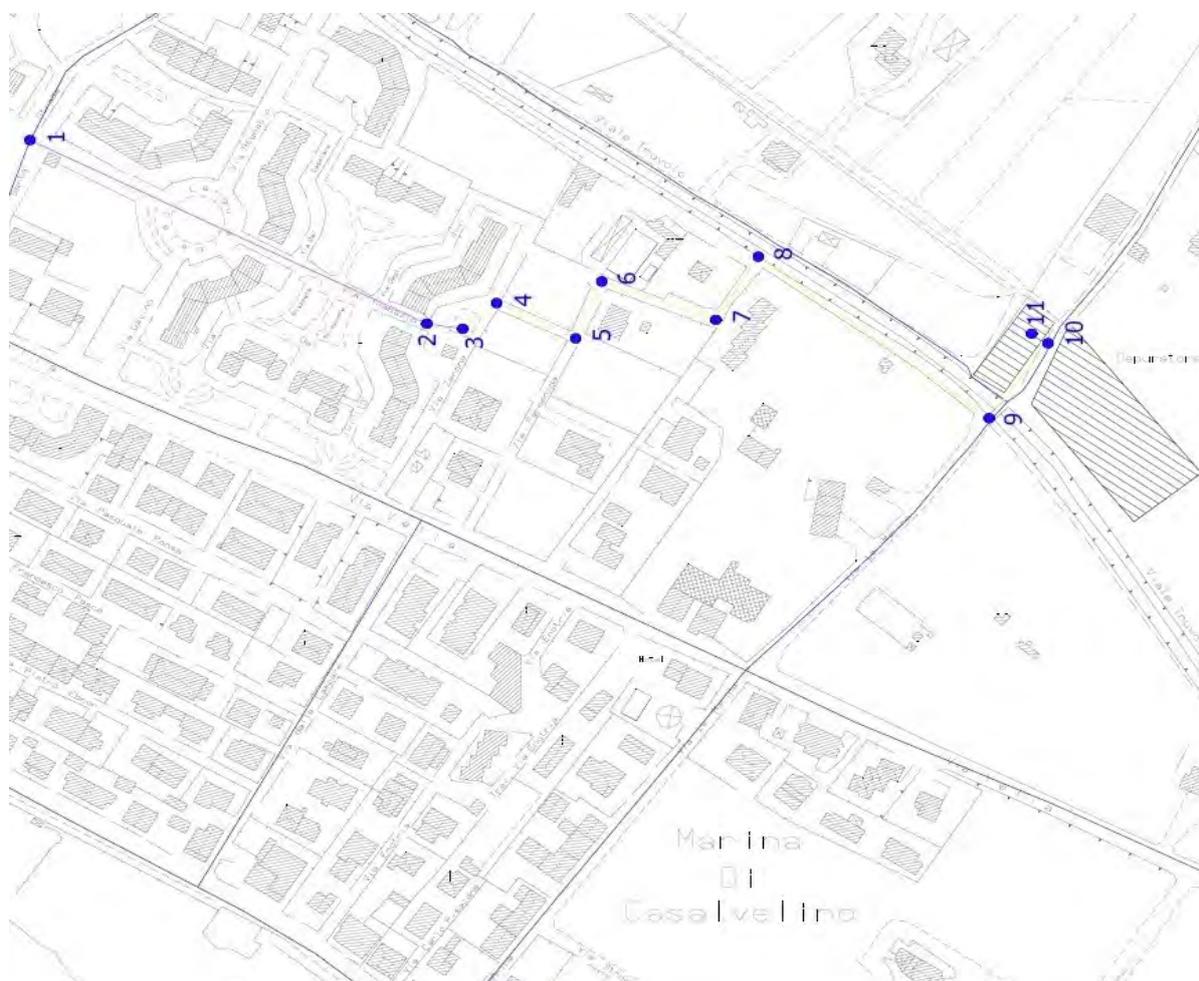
Planimetria con l'indicazione del tracciato, in giallo la condotta a pressione, fuori scala.
